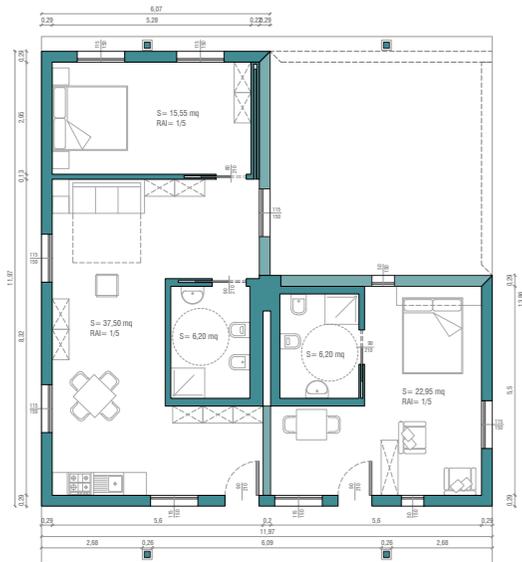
Pianta modulo triplo con pareti chiuse - variante 2.
